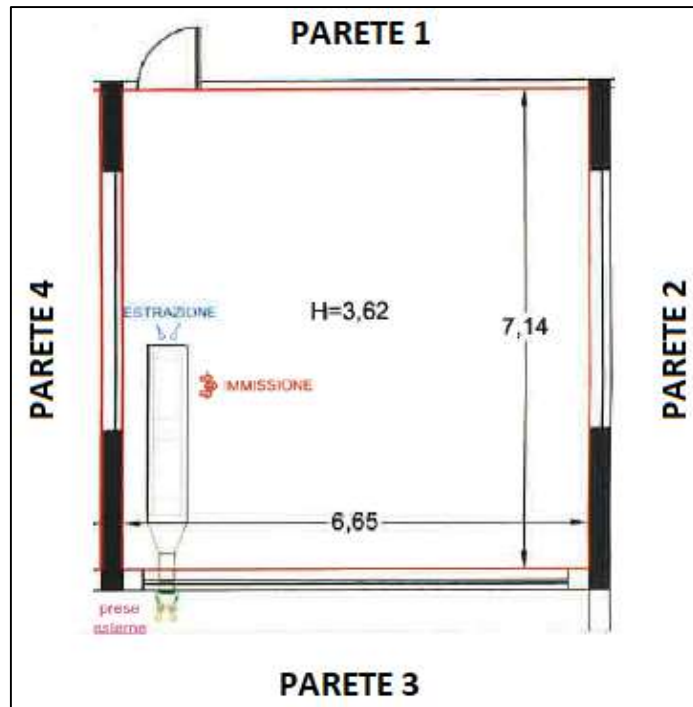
Planimetria dell’aula 3°B oggetto di simulazioni
